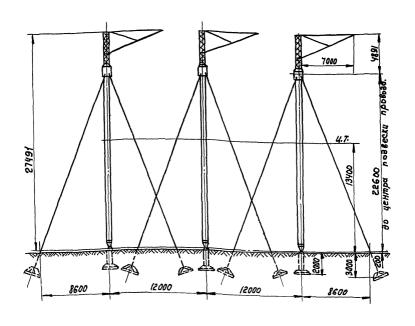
Общий вид и характеристика анкерно- угловой железобетонной опоры на оттяжках уб-500-1.
